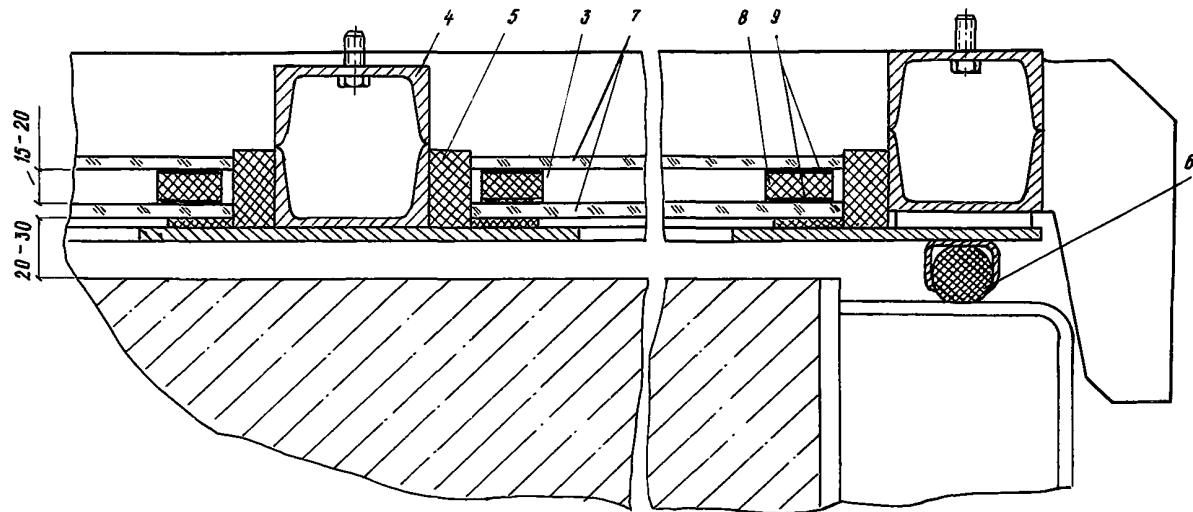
Гелиокрышка со светопрозрачным вкладышем из стекла
